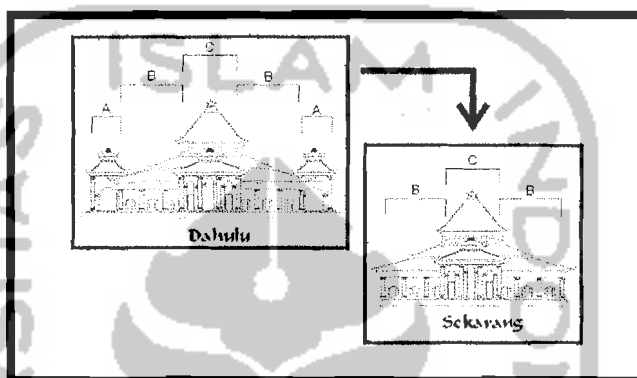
keseimbangan pada fasad dan tata ruang bangunan asli
